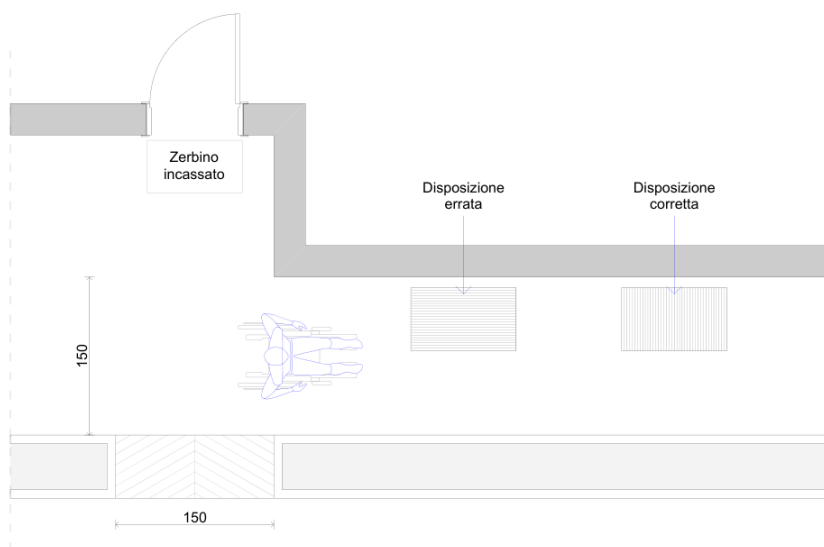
Pavimentazione: requisiti di planarità e antisdrucciolo
